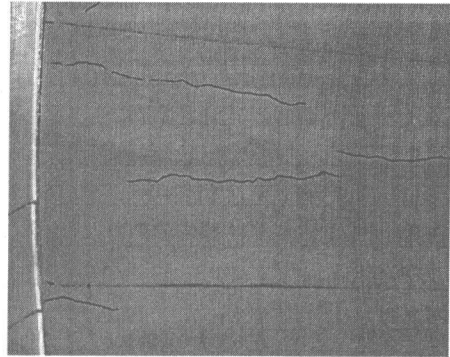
急曲線用推進管のひび割れ状況 (7.84MN時)
